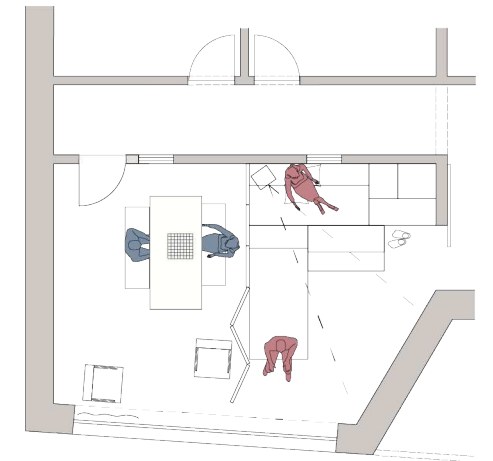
Grundrissvariante 3 - Parallele Nutzung individuell und gemeinschaftlich
